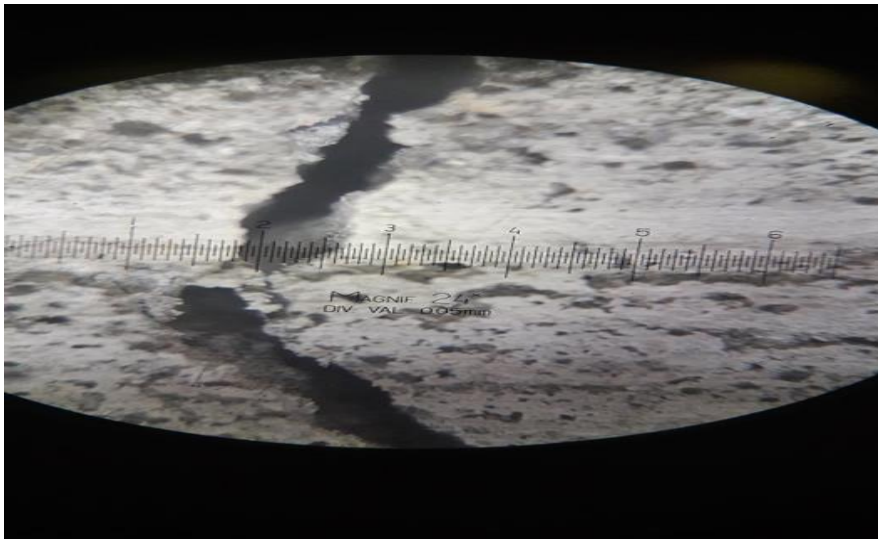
Mesure de la première fissure sur la poutre en béton fibré
